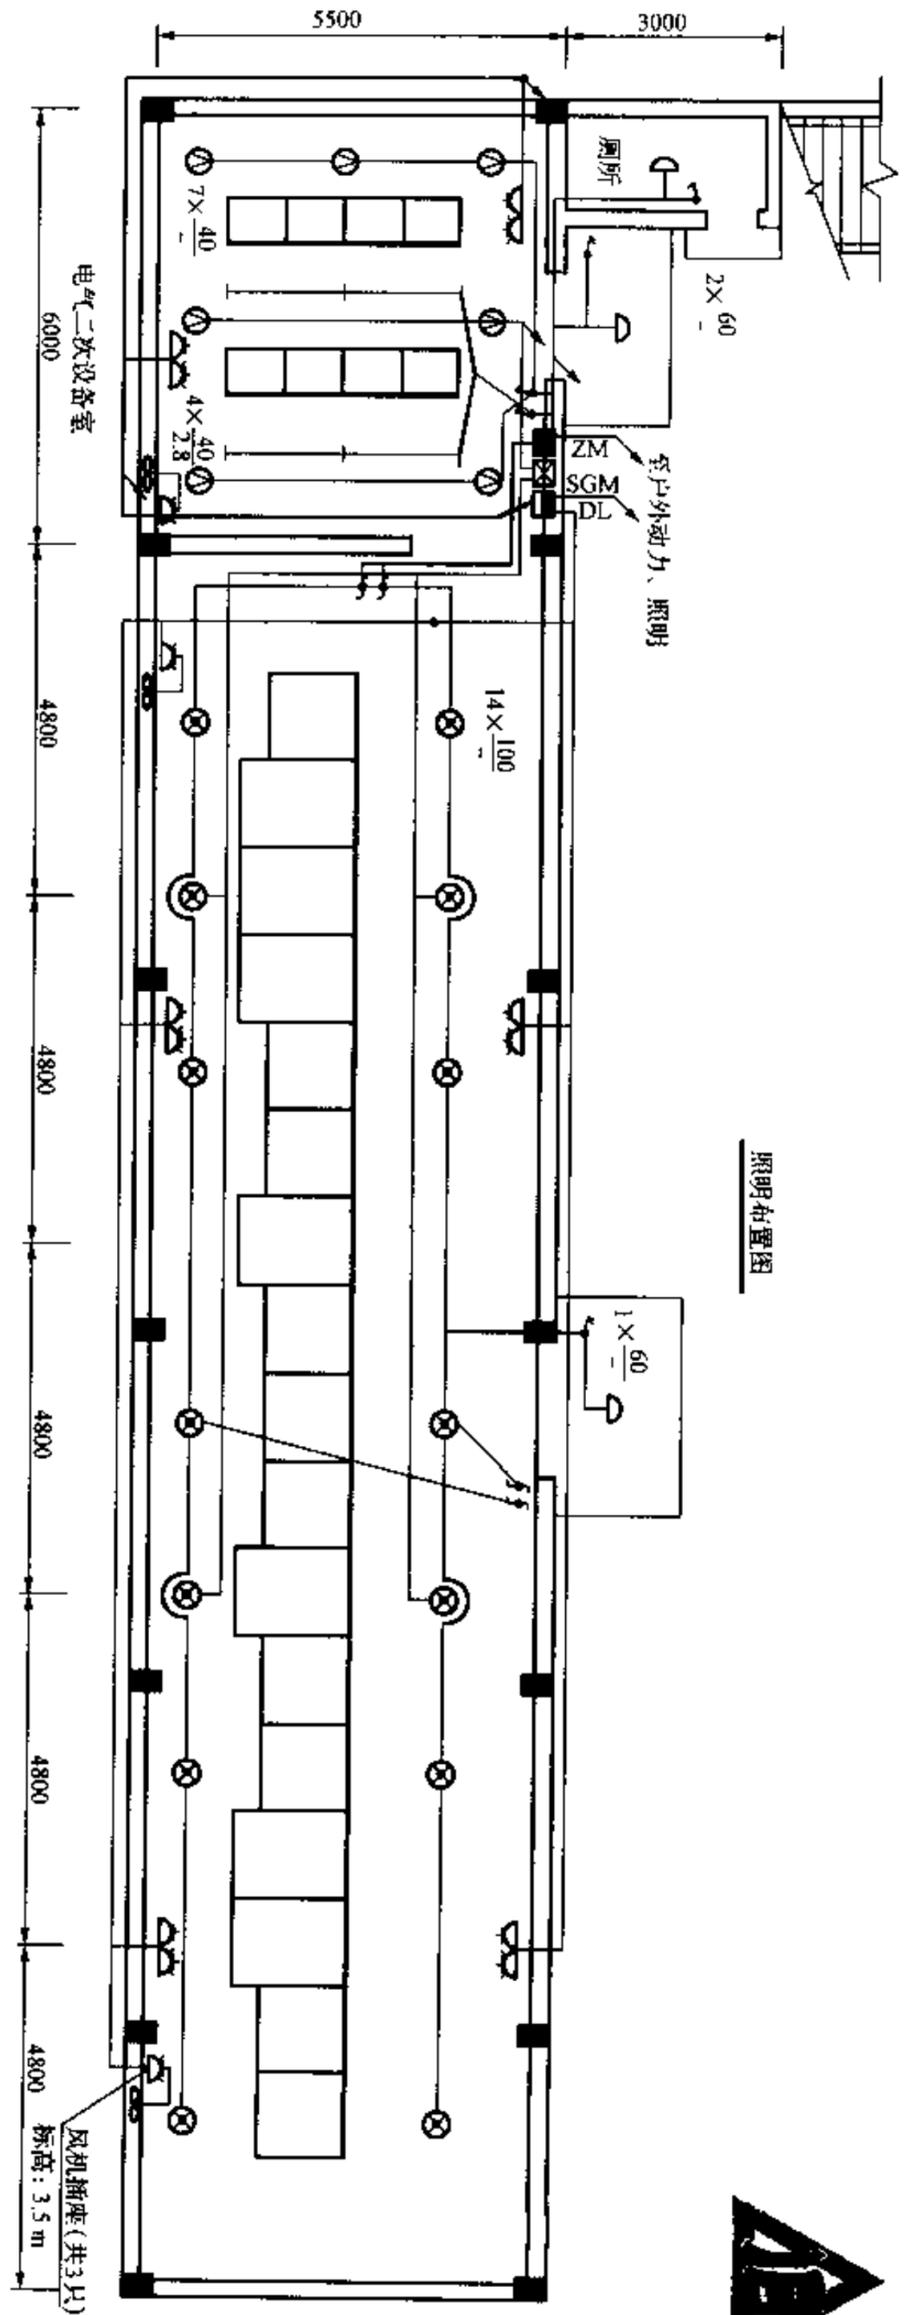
10 kV 屋内配电装置平面布置图 (二)
